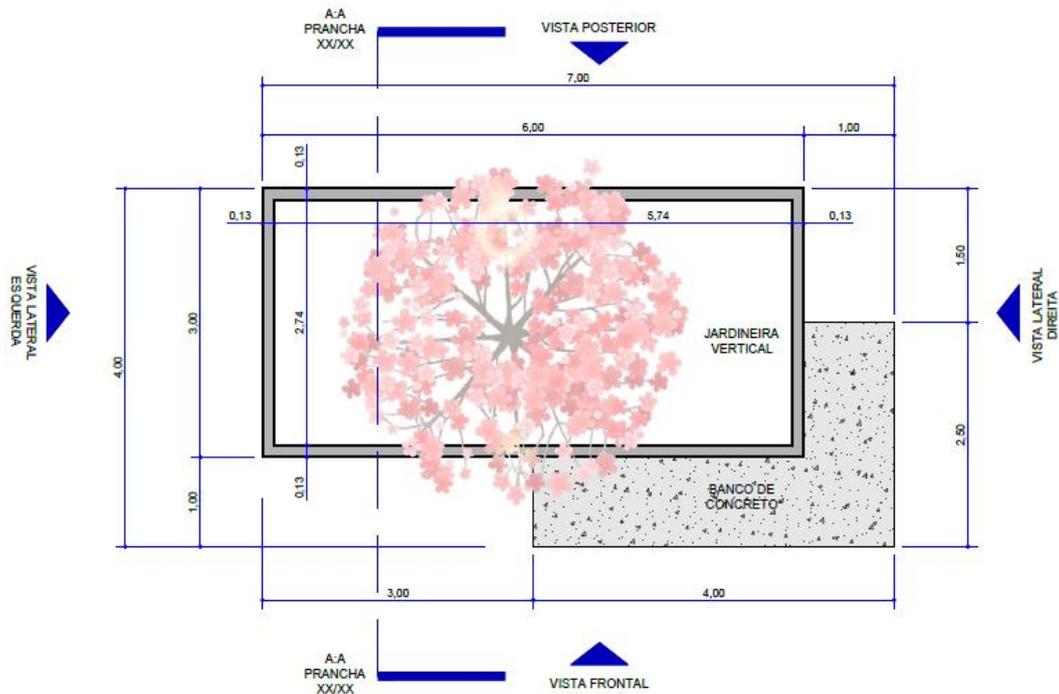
PLANTA BAIXA JARDIM VERTICAL – ESPECIFICADO EM PROJETO DE ARQUITETURA
